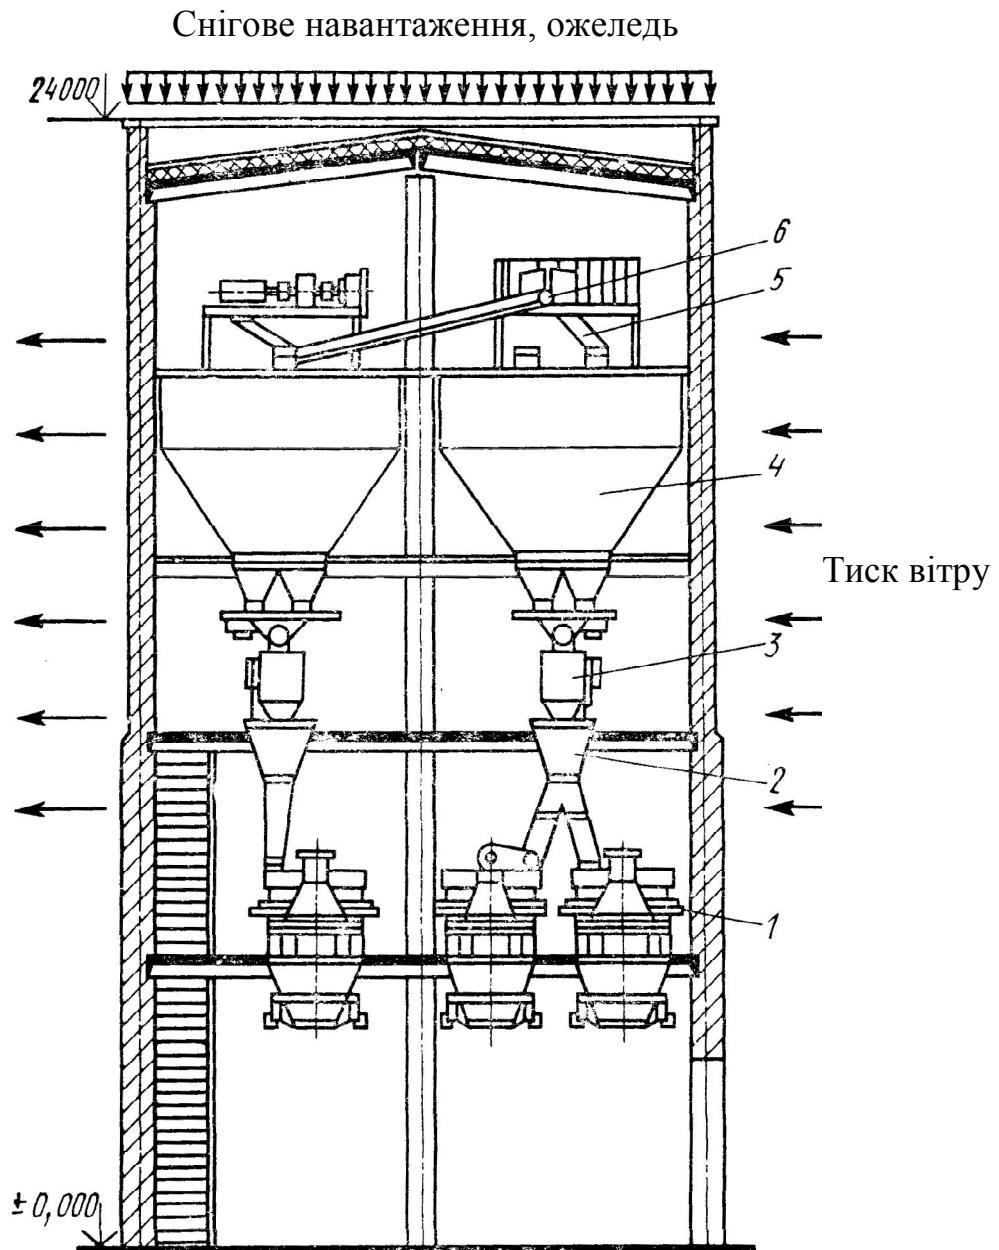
Схема дії силових навантажень на конструкцію бетонозмішуючого вузлу.
